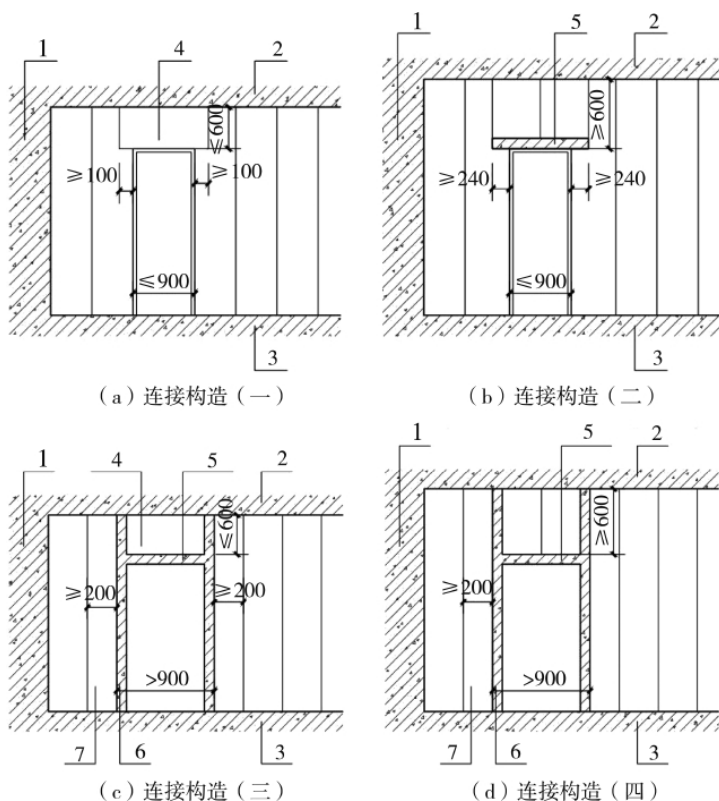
蒸压加气混凝土内墙板门窗洞口连接构造示意图
